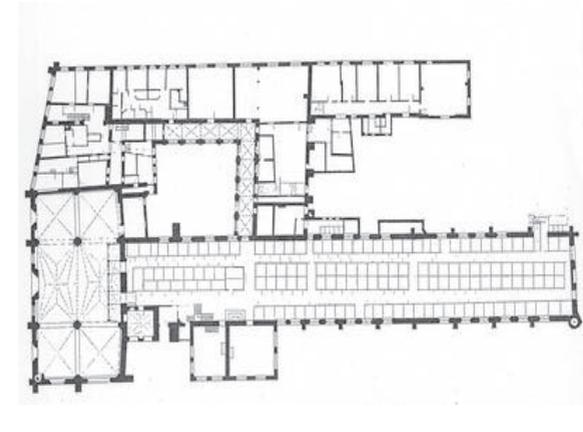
Grundriss der Anlage (Hauptraum im Anschluss an Kirche)
